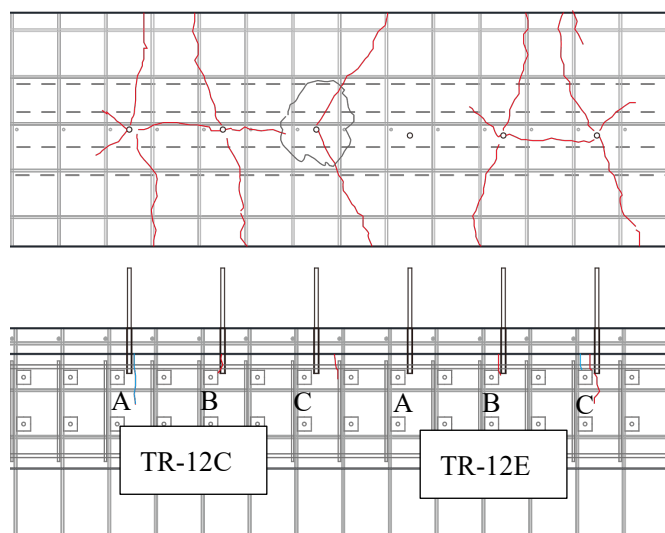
ひび割れ図（TR-12Cシリーズ，TR-12Eシリーズ）
